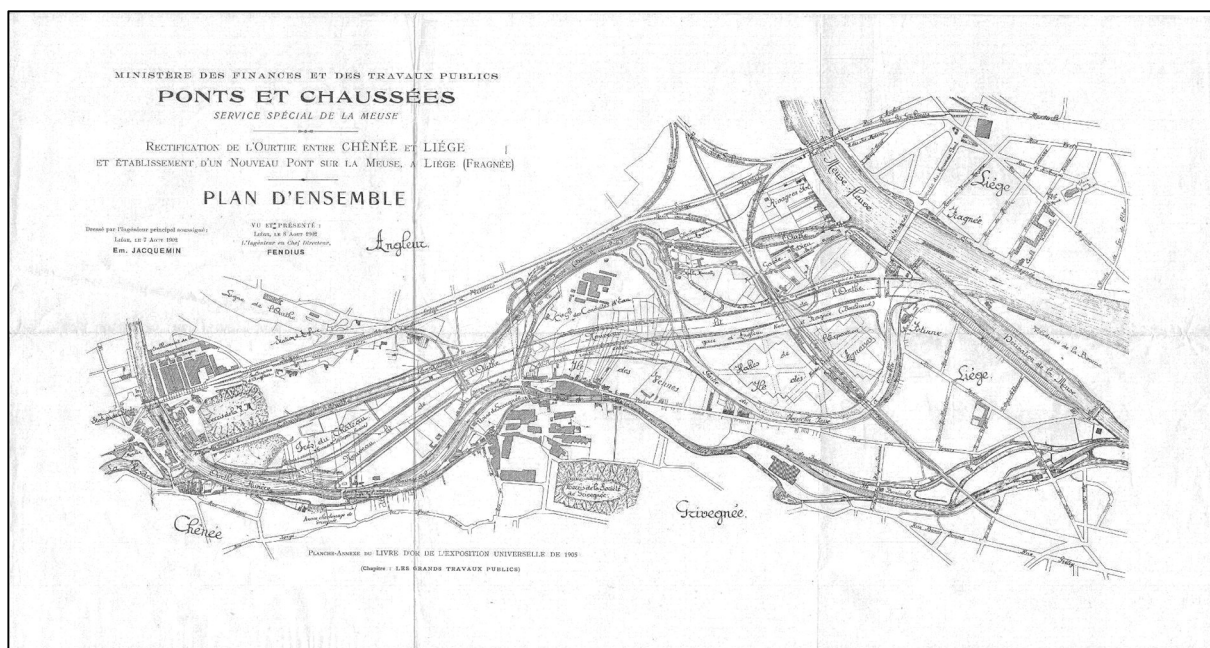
Plan d'ensemble des travaux de rectification de l'Ourthe et établissement d'un Nouveau Pont sur la Meuse de 1902
